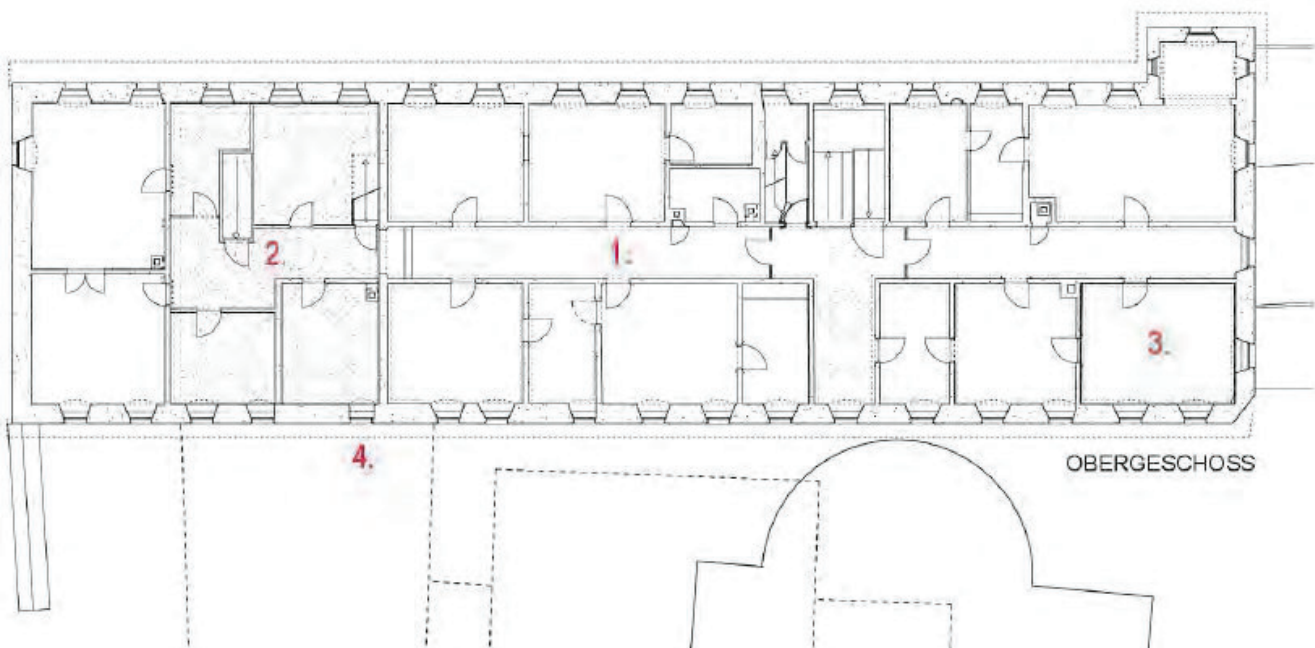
Aktueller Grundriss des Obergeschosses mit Benennung von Raumnutzungen zur Klosterzeit: (1) Zellengang/Dormitorium, (2) Saal als Gelenkstück zum Westflügel, (3) Priorat, (4) Zugang zum Westflügel (Grundriss: Timo Raible 2018).
